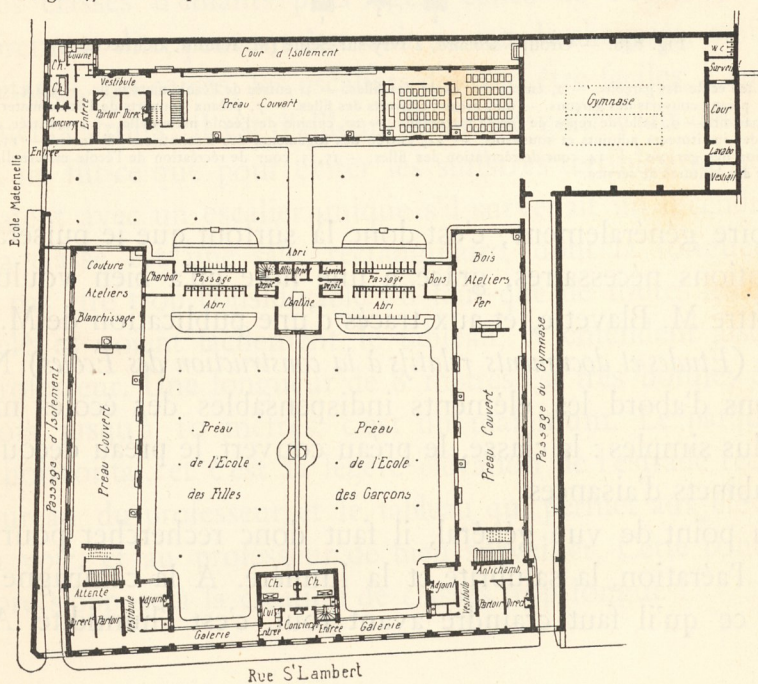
Groupe scolaire, à Paris (M. Bouvard, architecte). Plan du rez-de-chaussée
